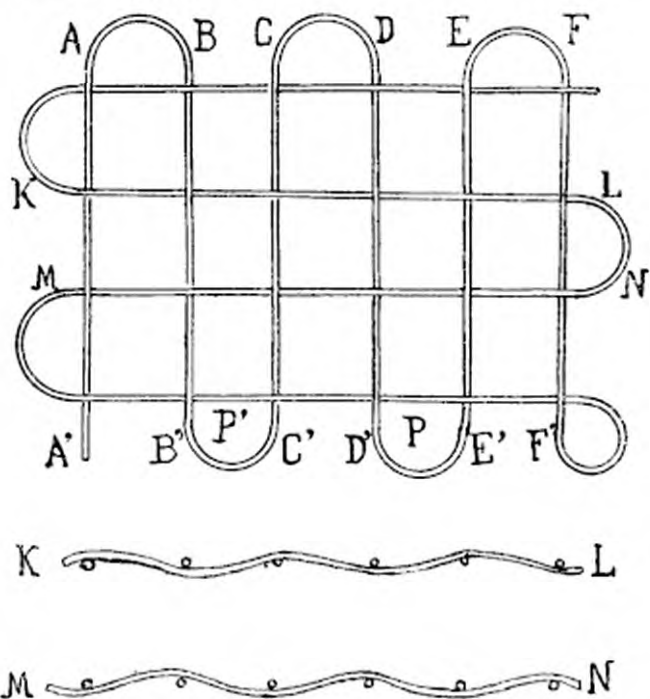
Toile métallique pour constructions en ciment armé, système Cottancin.
